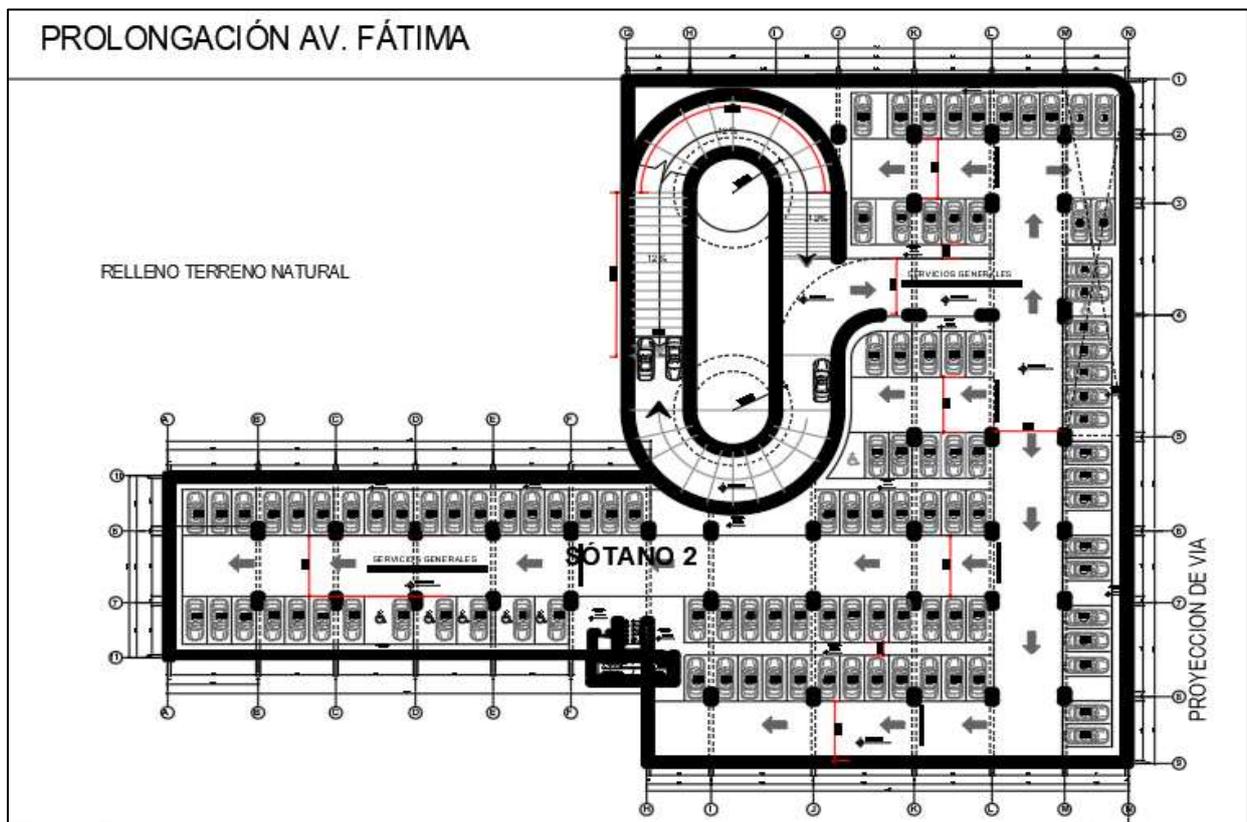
Vista plano de sótano. FUENTE: Elaboración propia.
